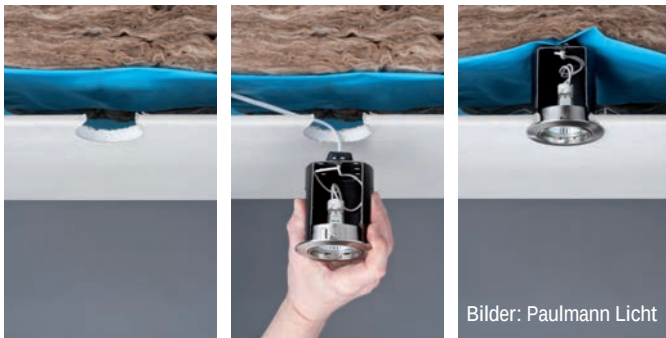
Bedenklich ist der nachträgliche Einbau von Deckeneinbauleuchten. Der fachgerechte Einbau ist nur möglich, wenn im Rahmen des Innenausbau Vorbereitungen getroffen wurden. Zu beachten ist ebenfalls der Brandschutz. Die Betriebstemperatur besonders von Halogenstrahlern kann den Schmelzpunkt von Kunststoffbahnen übersteigen.
